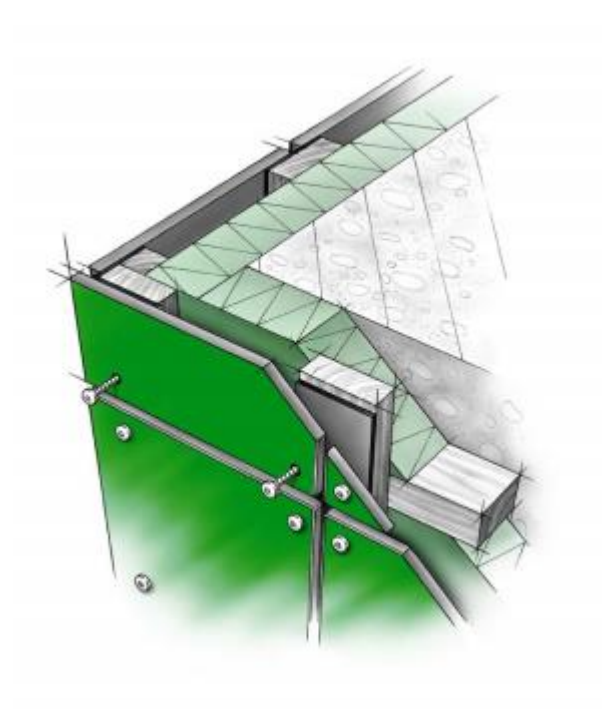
Coupe horizontale d'une fixation de panneau avec vis
